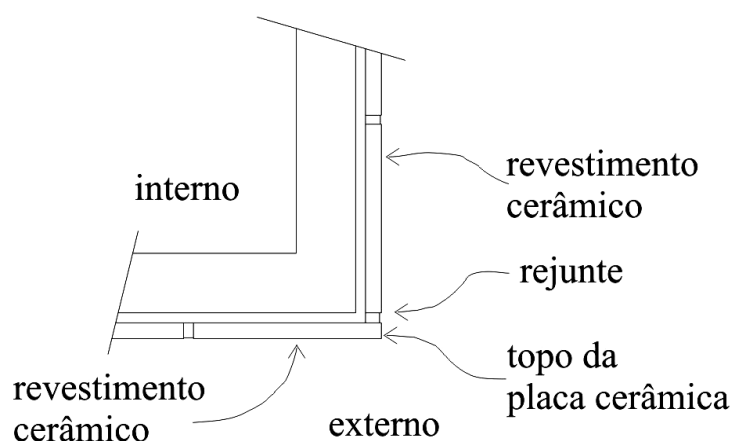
Encontro entre placas cerâmicas de fachadas adjacentes
